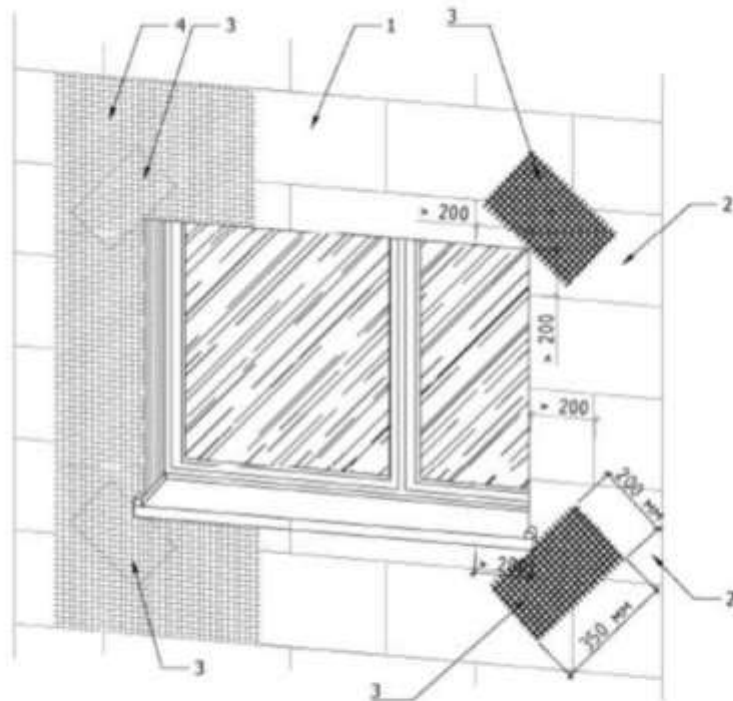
Загальна схема утеплення і армування віконних і дверних прорізів
